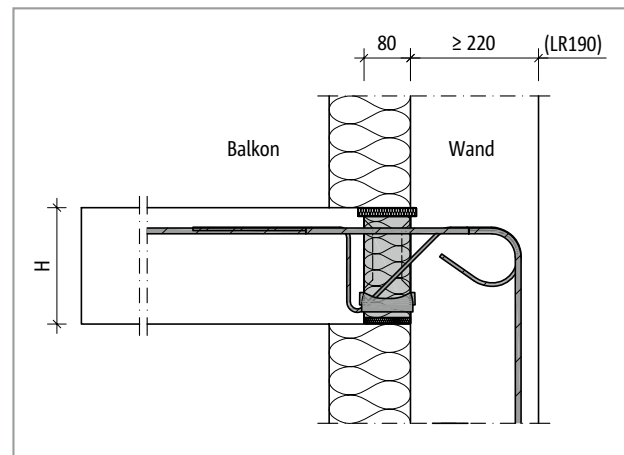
Schöck Isokorb® T Typ K-WU: Wandanschluss nach unten bei Außendämmung
